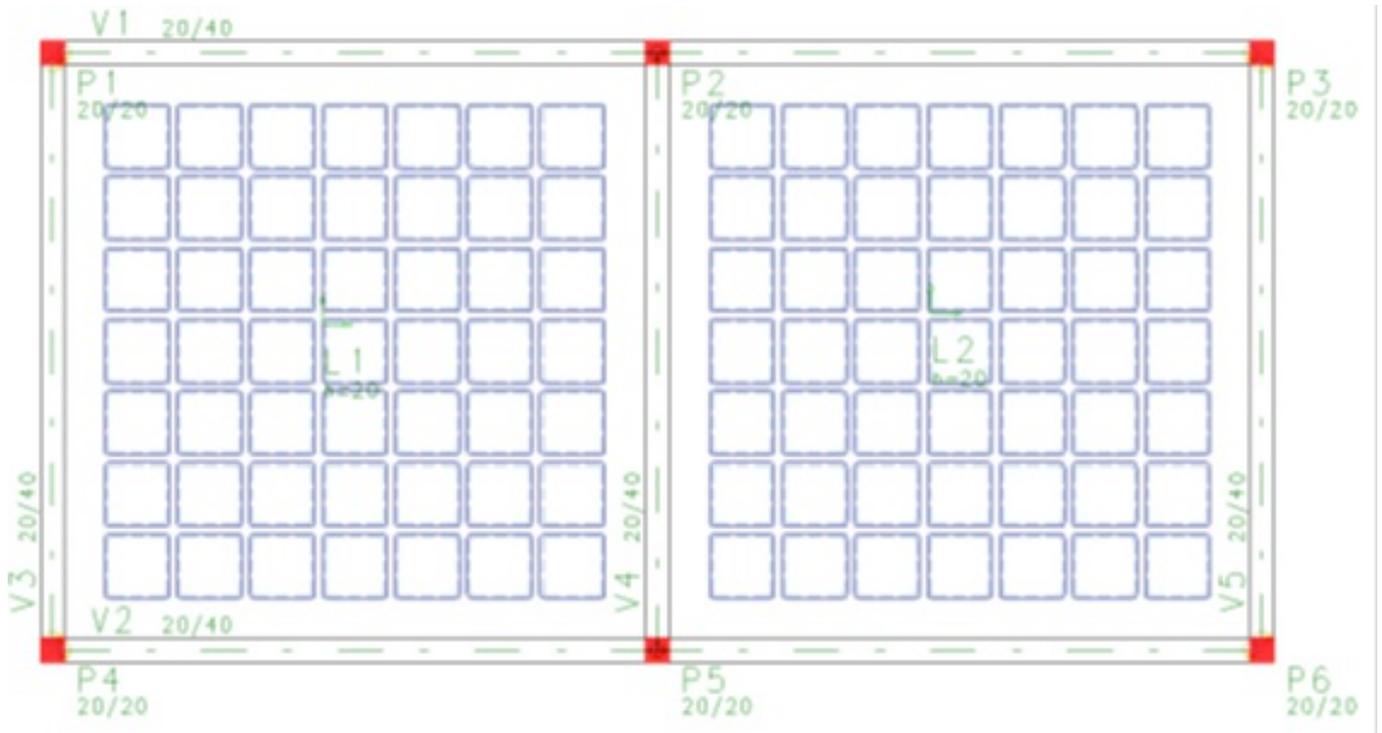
Lançamento de laje nervurada no Modelador Estrutural
